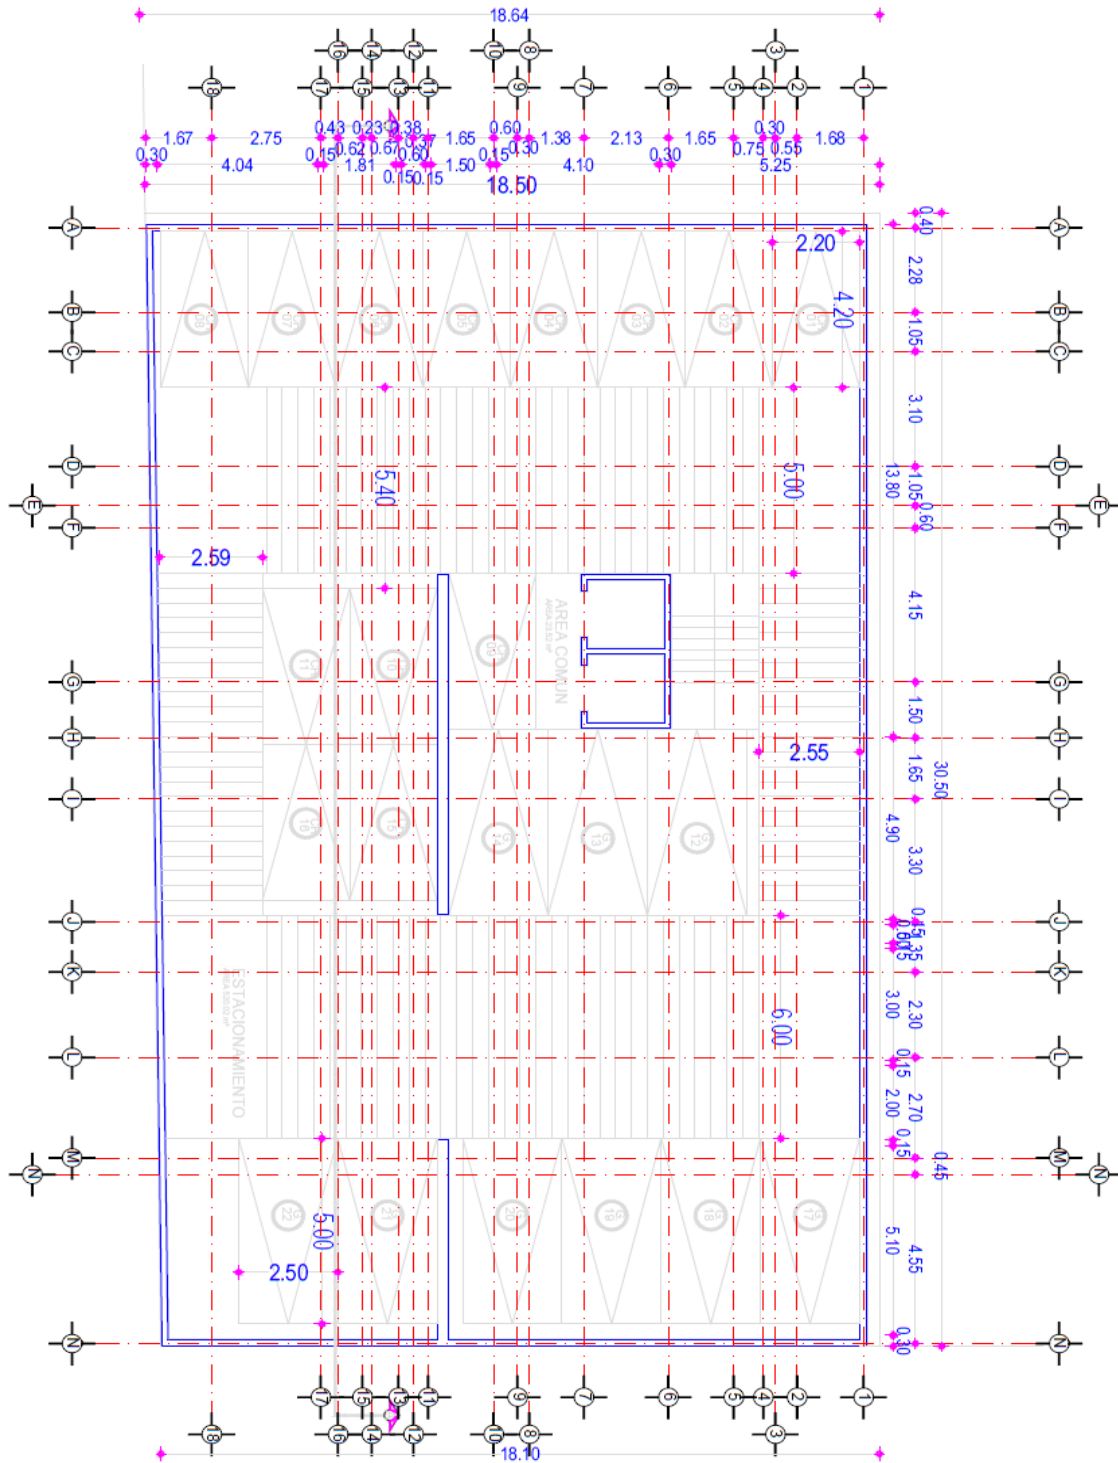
A.- PLANTA ARQUITECTÓNICA TIPO SÓTANO 1 – 4
